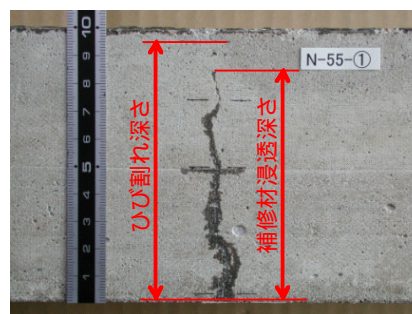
ひび割れ側面の状況の例 (エポキシ樹脂注入工法)
